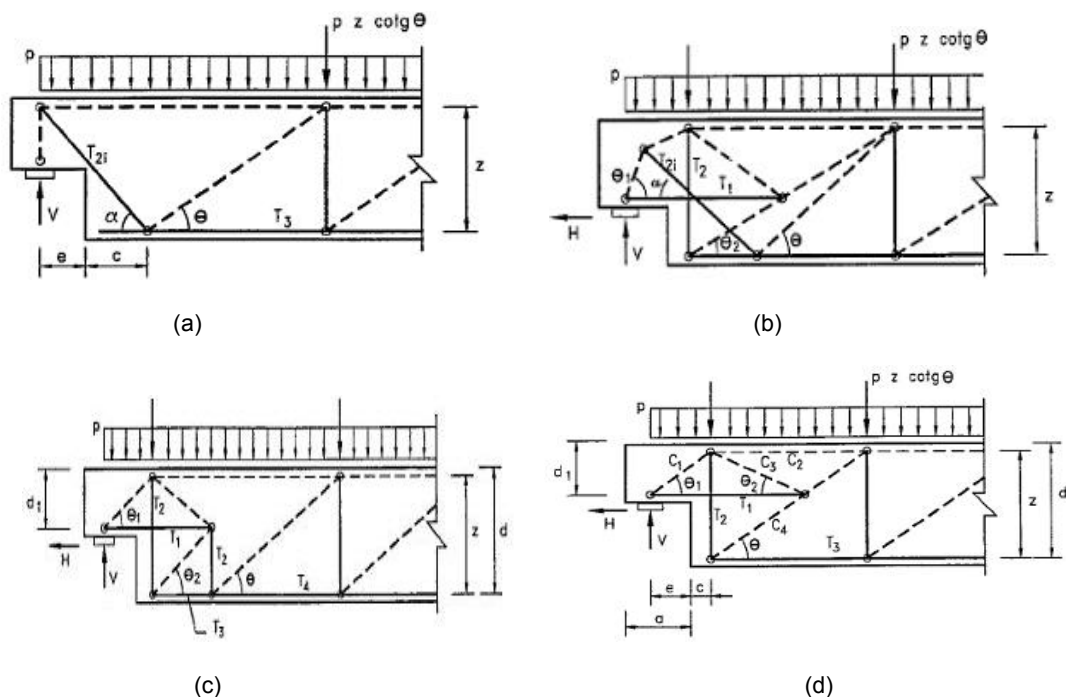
Pormenorização das armaduras em consolas curtas (extraída de [13])
